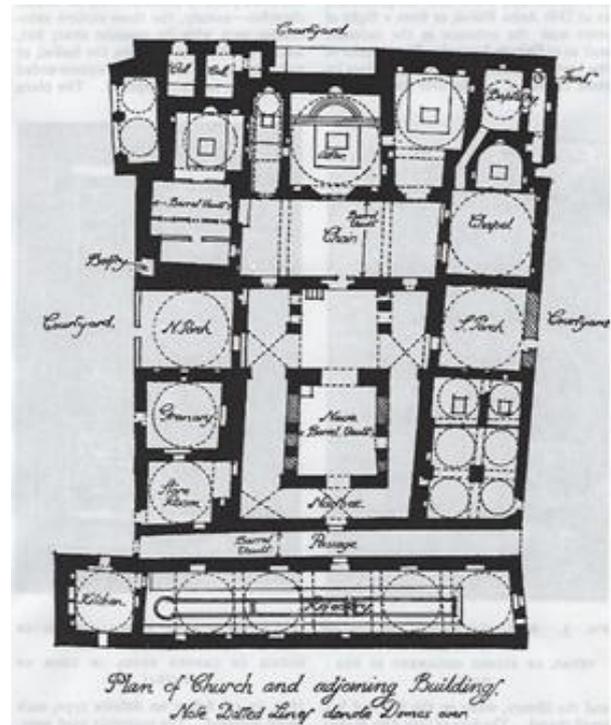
Grundriss der Bishoikirche nach Jones
